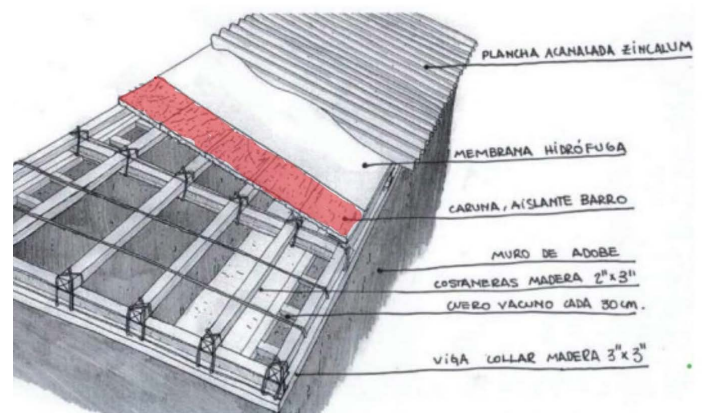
Isométrica constructiva vivienda restaurada en Tacora año 2018. Fuente: adaptación de los autores de Fundación Altiplano
